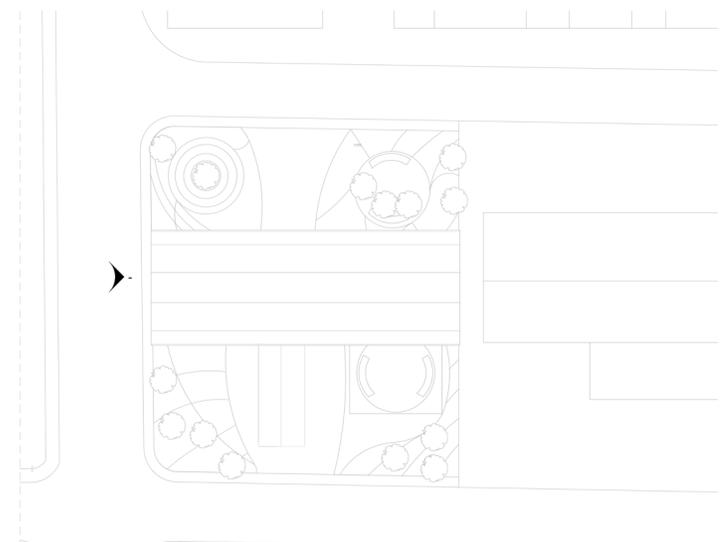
Localização Fachada Lateral Esquerda - Colmo
